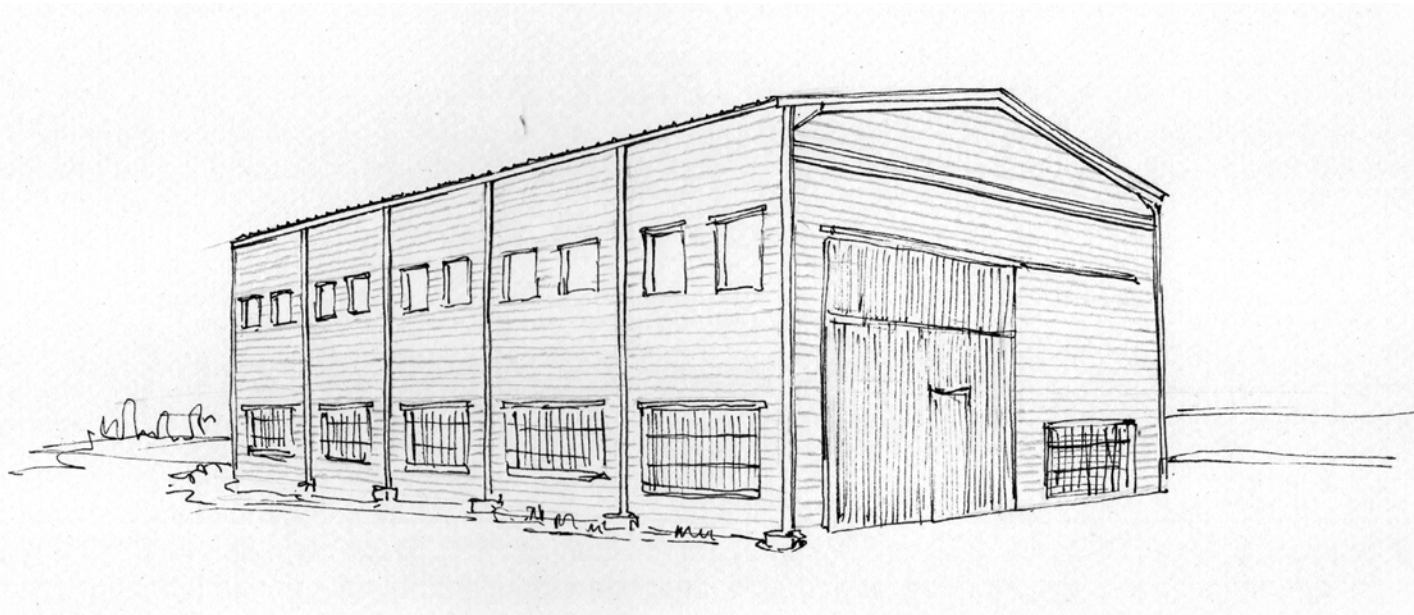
Secadero de piel de bloques de hormigón prefabricado. La estructura portante es de perfiles de acero laminado. La ventilación se produce mediante ventanales. La cubierta es de chapa grecada.
